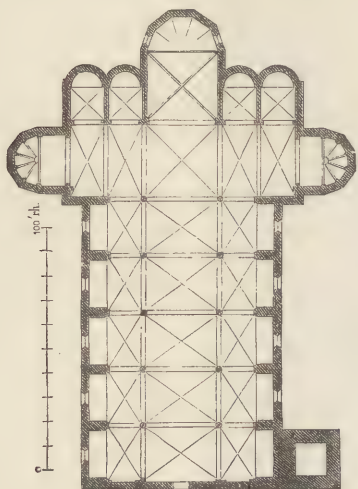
Servi zu Siena. Grundriss. (L.)
